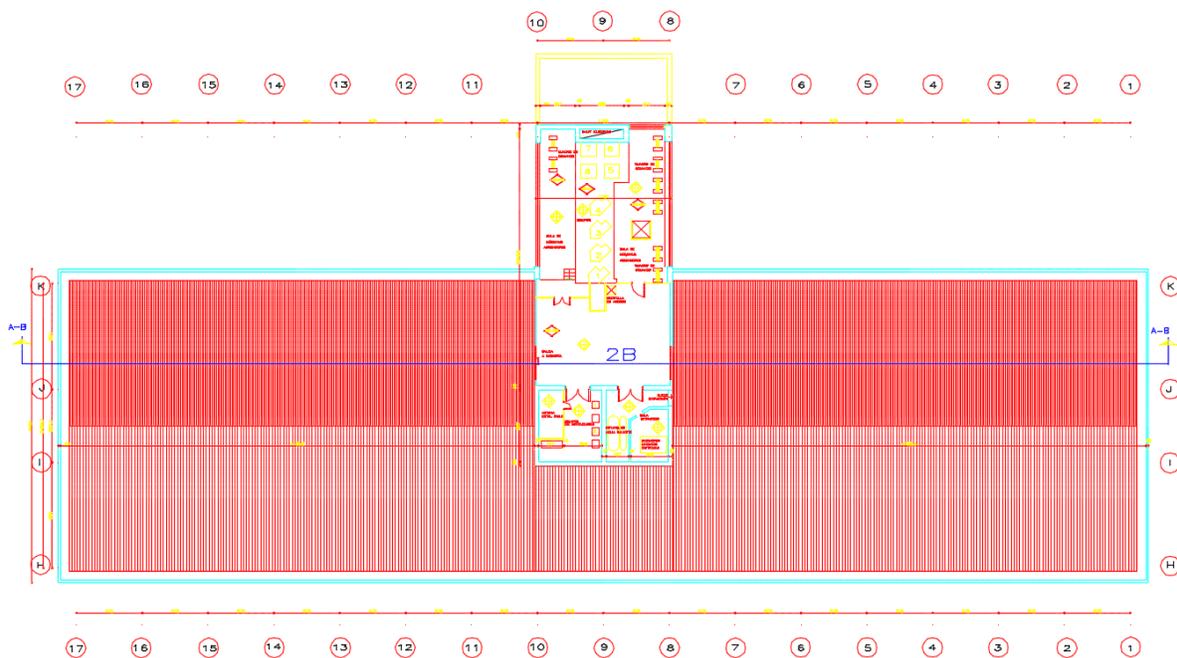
Planta de la cubierta de la torre hospital.
